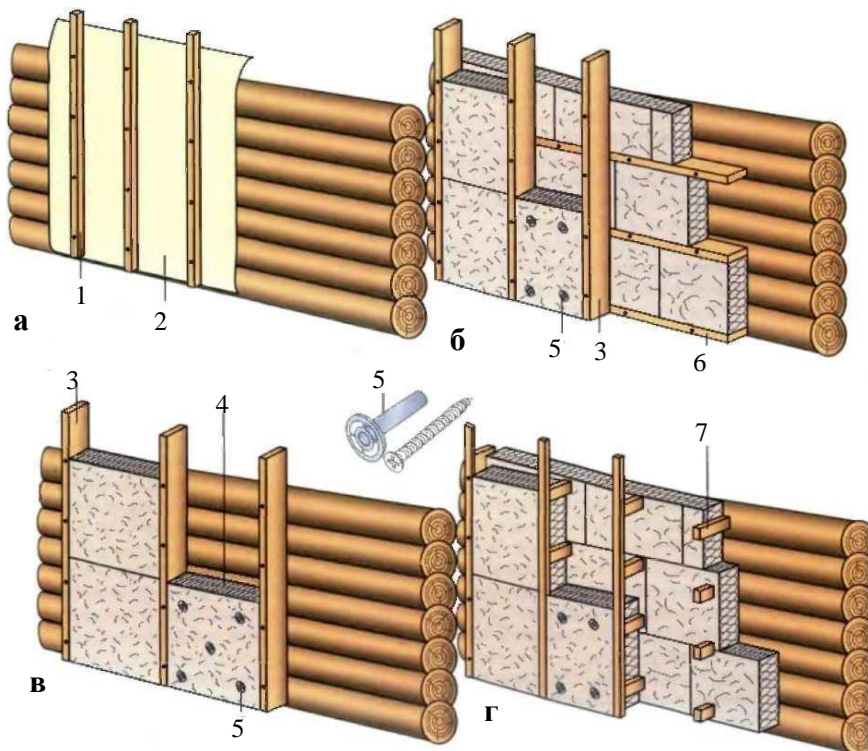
Теплоізоляція стін: а – рулонним утеплювачем; б – міжкаркасна в один шар; в – міжкаркасна у два шари; г – безкаркасна у два шари; 1 – лати; 2 – рулонний утеплювач; 3 – вертикальний каркас; 4 – плитний утеплювач; 5 – грибок; 6 – горизонтальний каркас; 7 – коротиші
